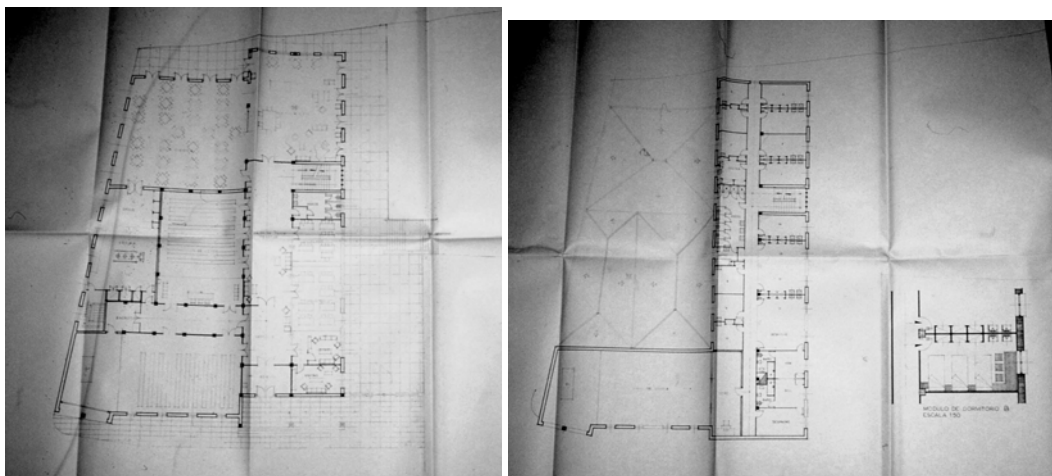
y 176. C. M. Santa María de los Ángeles: bajo y primer piso, por F. Población, diciembre de 1961.
